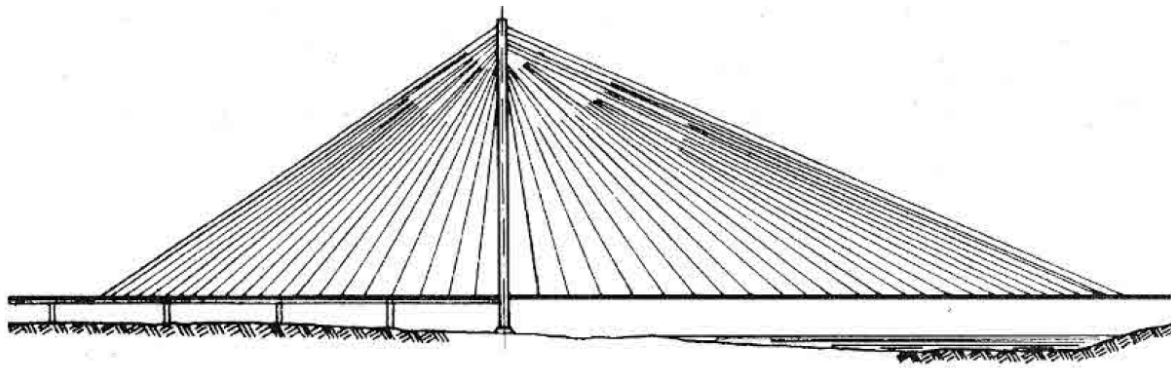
Una disposición mixta de cables dispuestos en abanico y en arpa facilita el anclaje en la parte superior del pilón.
